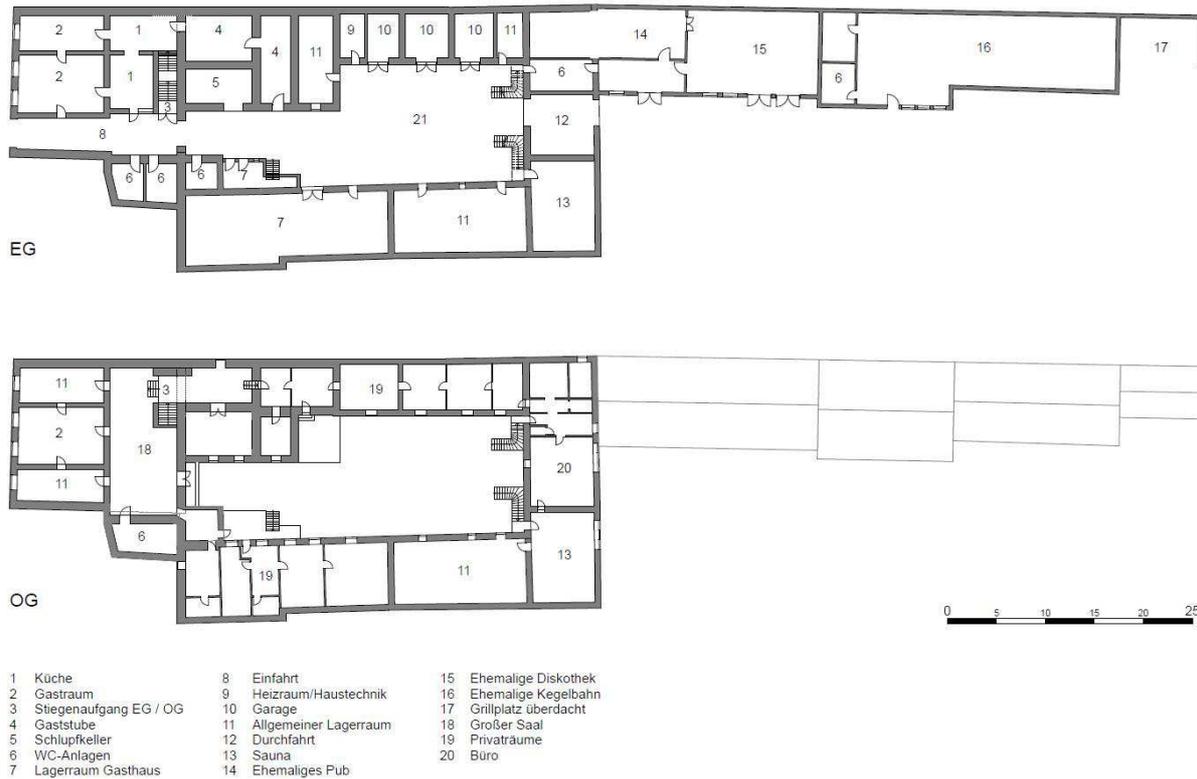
Grundrisse Bestandsnutzung
